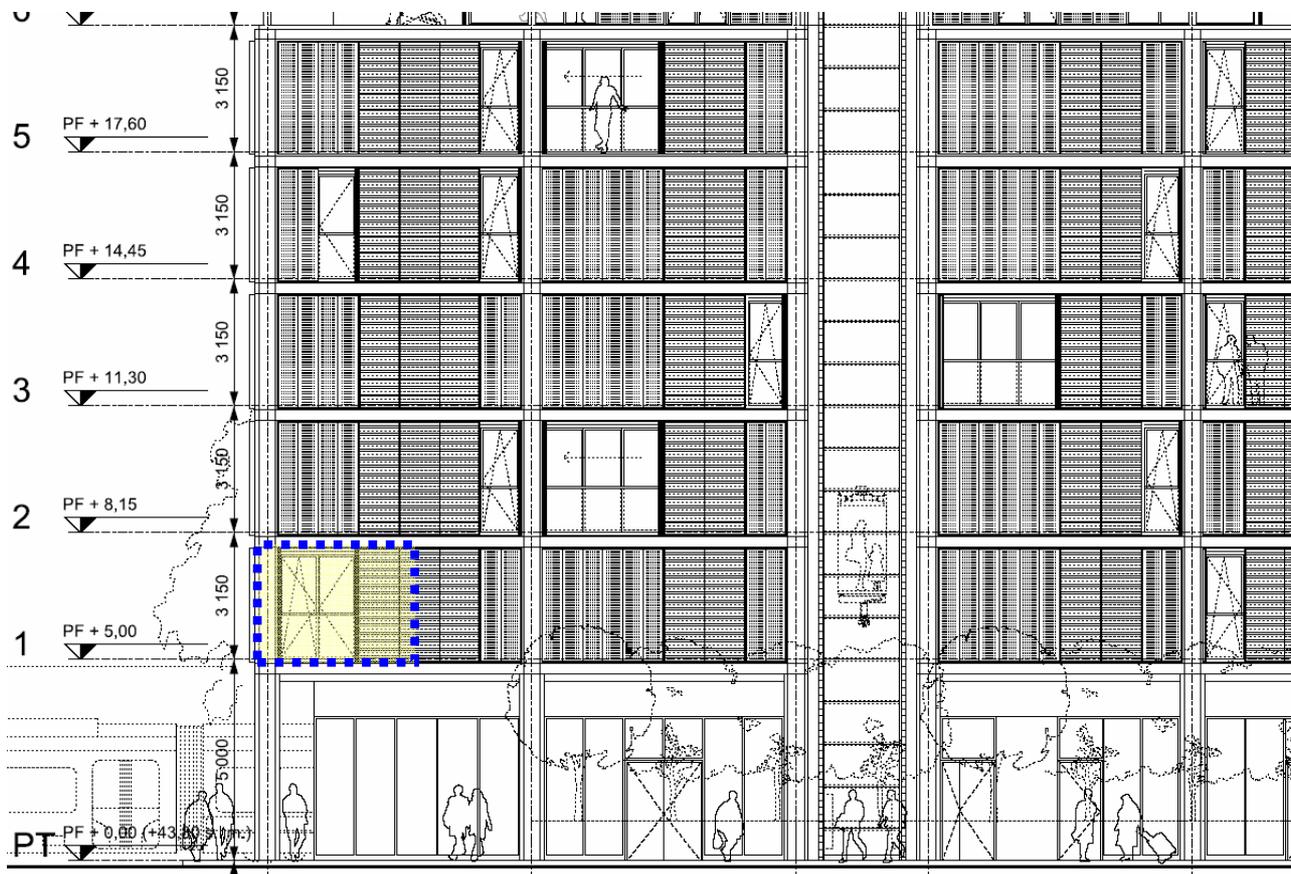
Indicazione in prospetto della facciata oggetto di valutazione
